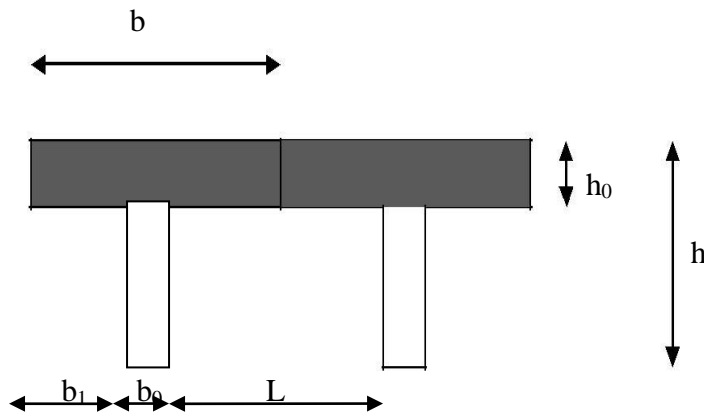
Section de la poutrelle après coulage de la dalle de compression.
